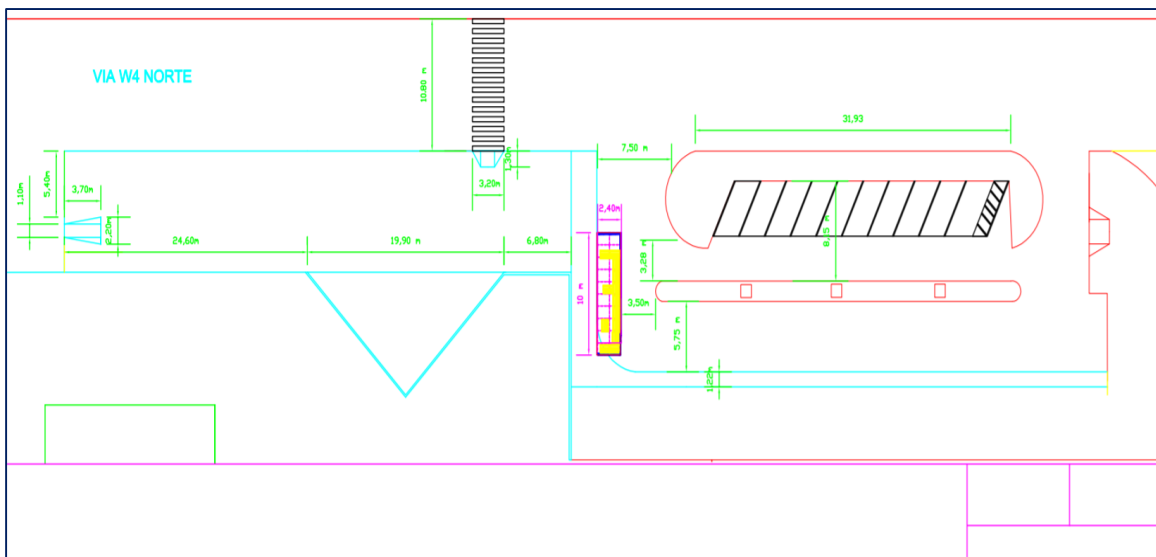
Vista Frontal da área de implantação do Parklet, acesso D, UniCEUB.
